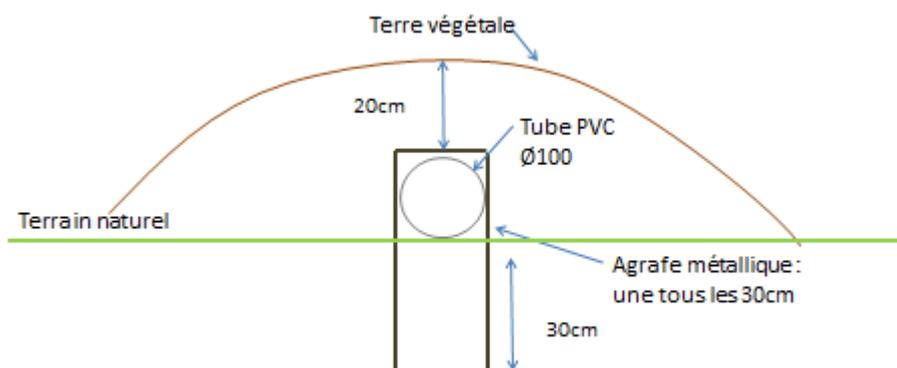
Installation d'un dispositif d'agrafes pour la fixation du tuyau entre deux filtres.
